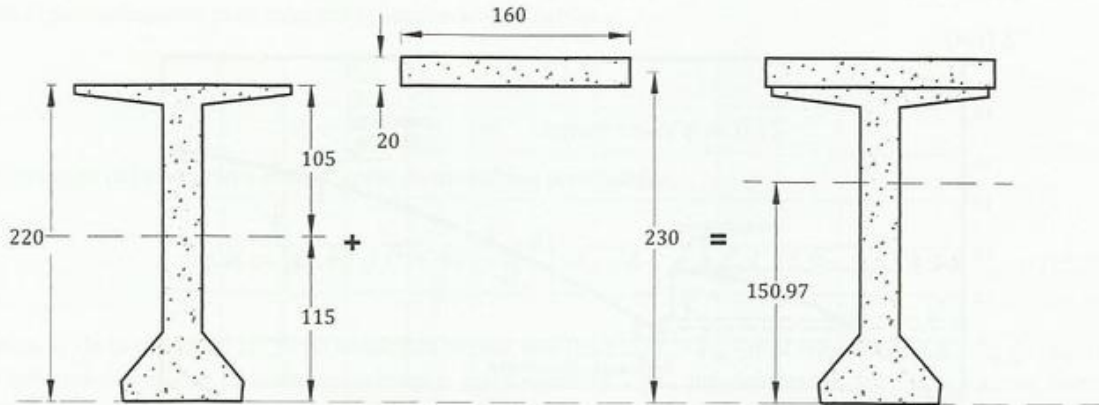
Sección compuesta viga del Ejemplo 15.5
